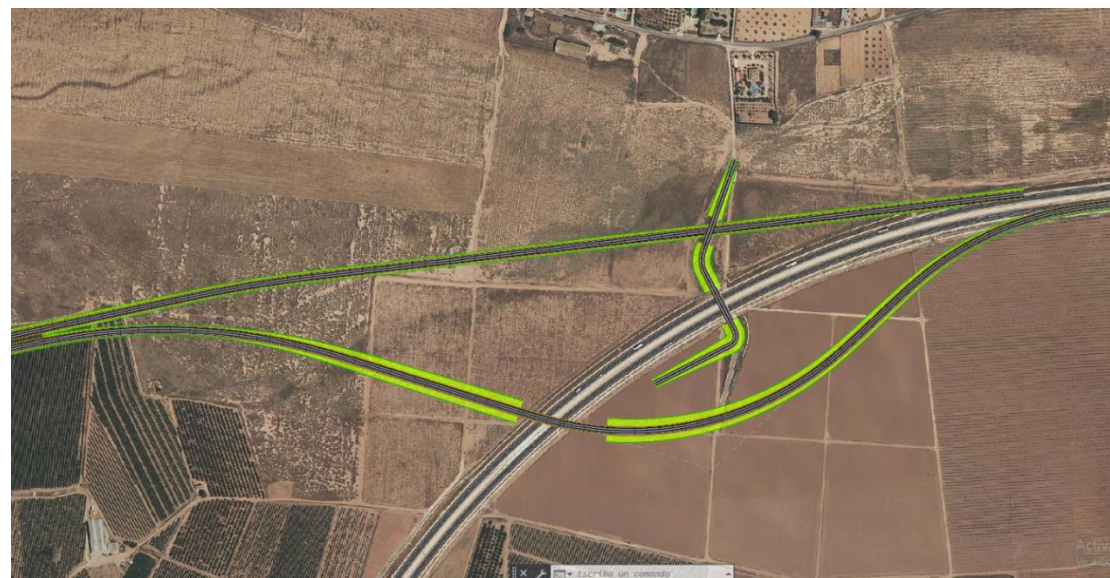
Planta del enlace con la A-33. Fuente: elaboración propia.
